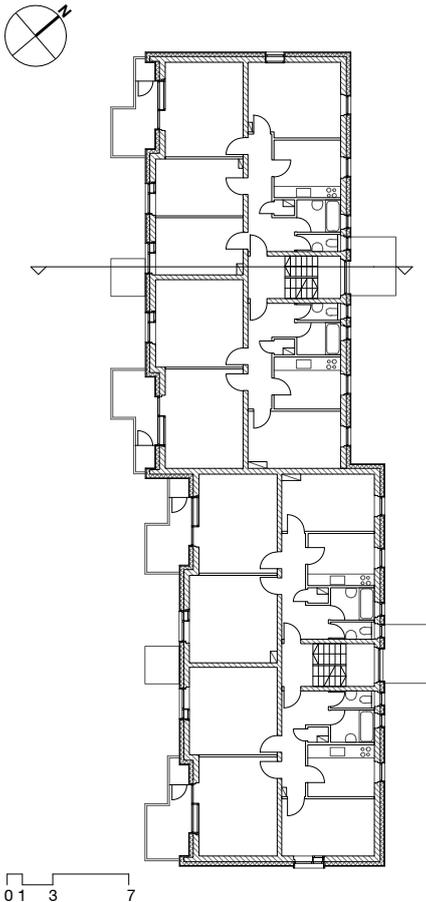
Grundriss 1. OG nach Modernisierung
